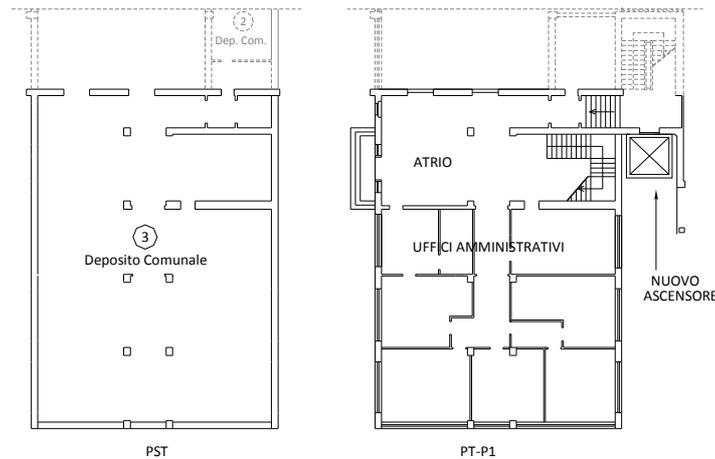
5: Pianta dei vari piani del blocco B.
